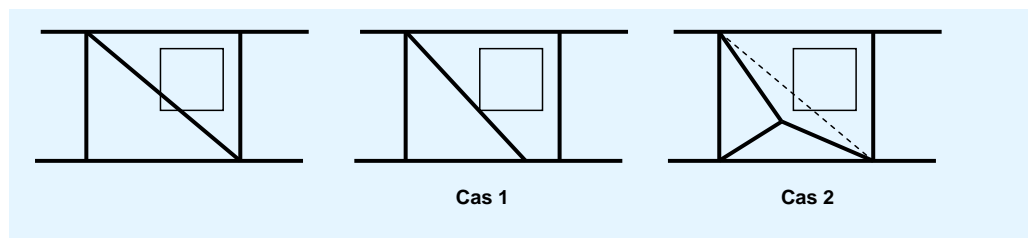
Passage d'un conduit – Modification locale du treillis
